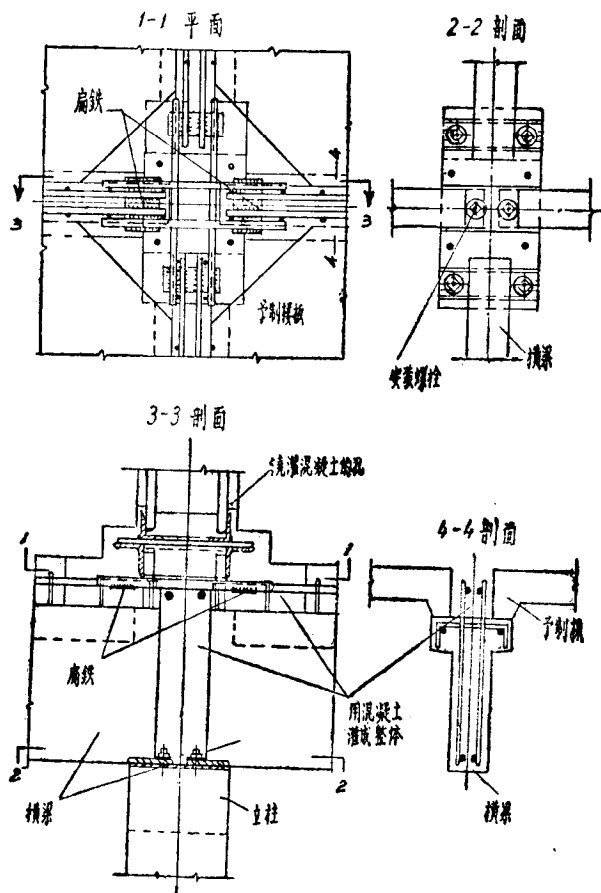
经过浇灌的钢筋混凝土传递内力的骨架构件联接点的解决示例
